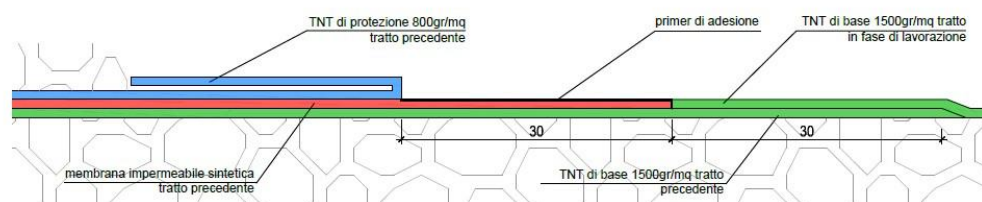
b - Ripresa dell'impermeabilizzazione in rosso
